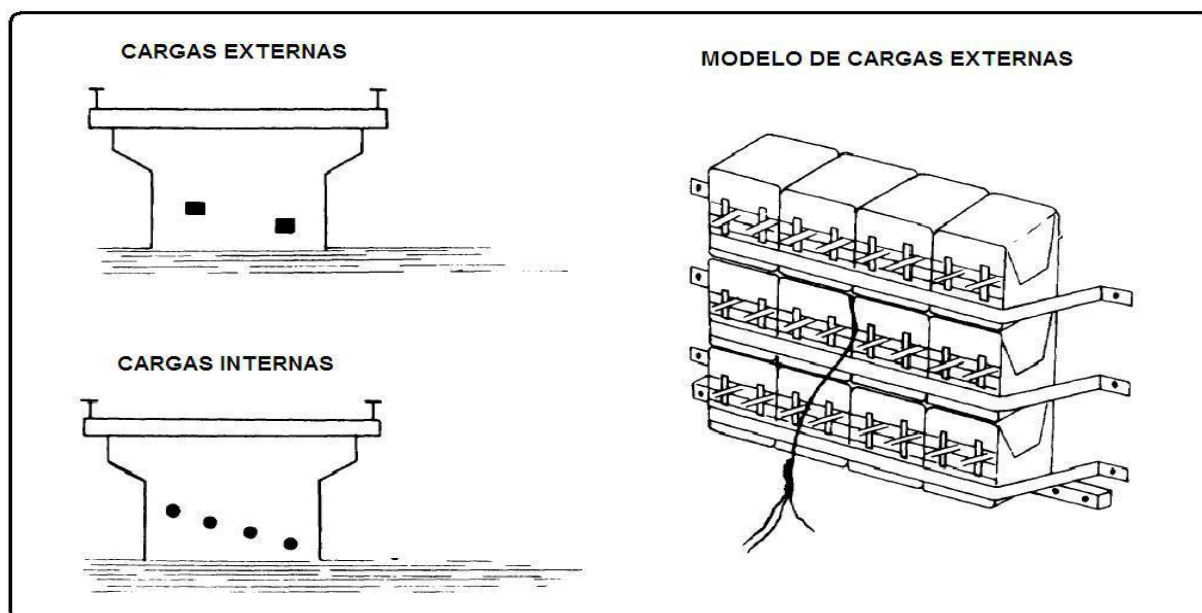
Posicionamento de cargas para demolição de pilares de ponte
